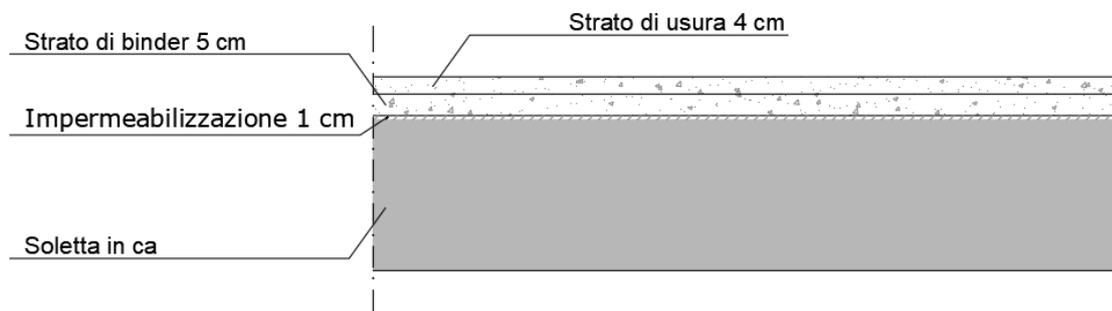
Sovrastruttura tipo per pavimentazioni su impalcato
